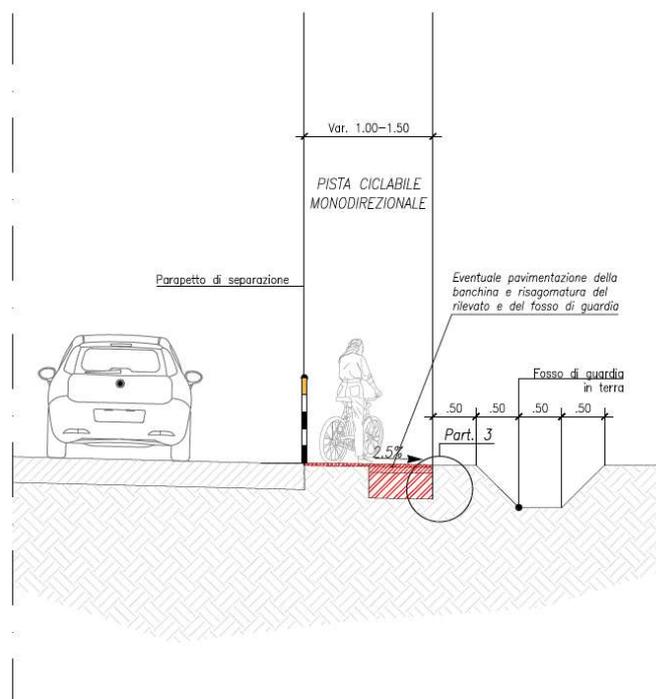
Sezione tipo 4: Pista ciclabile su sede separata con parapetto
